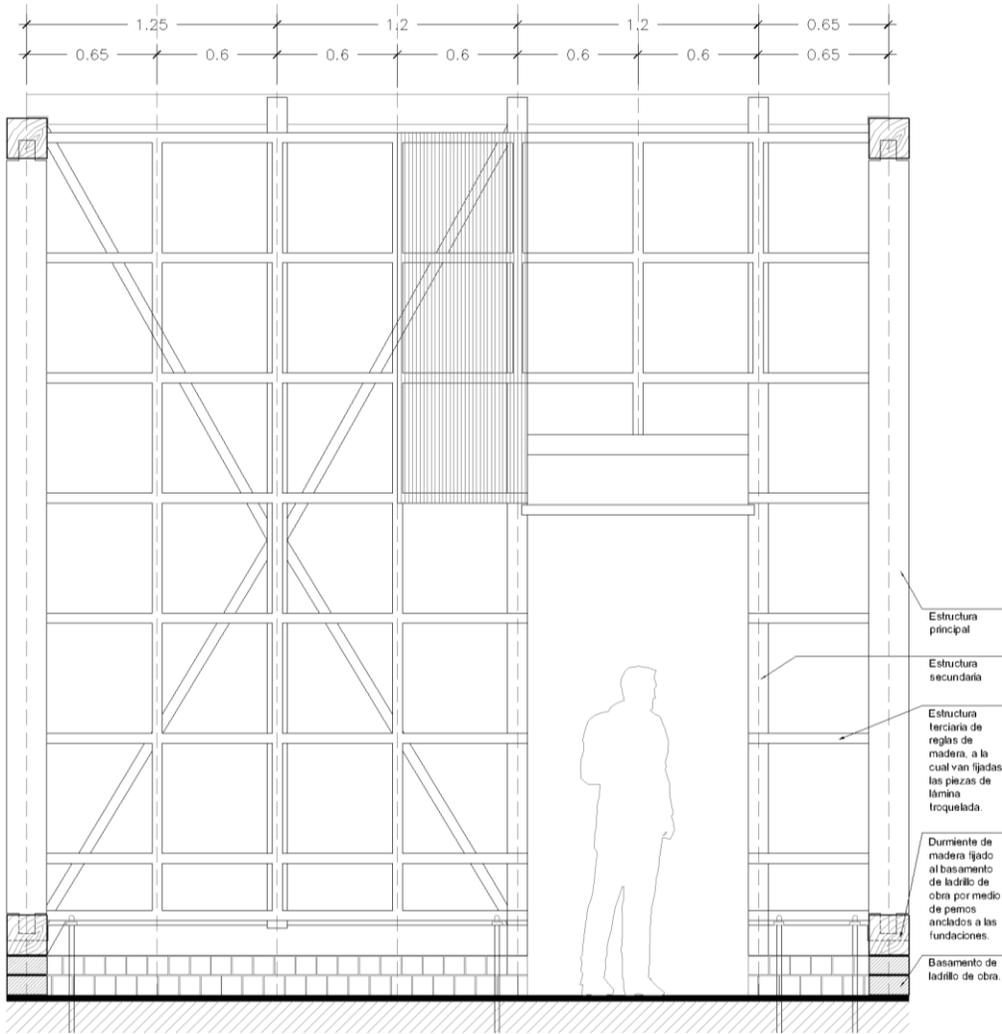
Detalle típico de estructura de pared (elaborado en base a mediciones en la Casa Rey Prendes).
